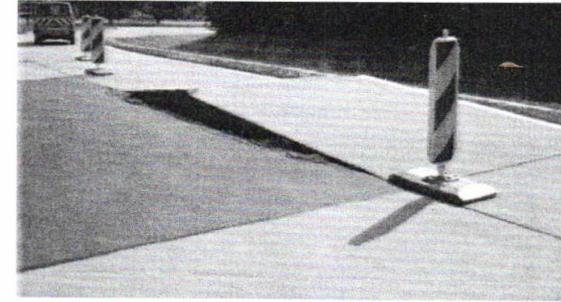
Typischer Hitzeschaden mit „Dachprofil“ als Folgeschaden eines Plattenersatzes im benachbarten Fahrstreifen in Asphaltbauweise
